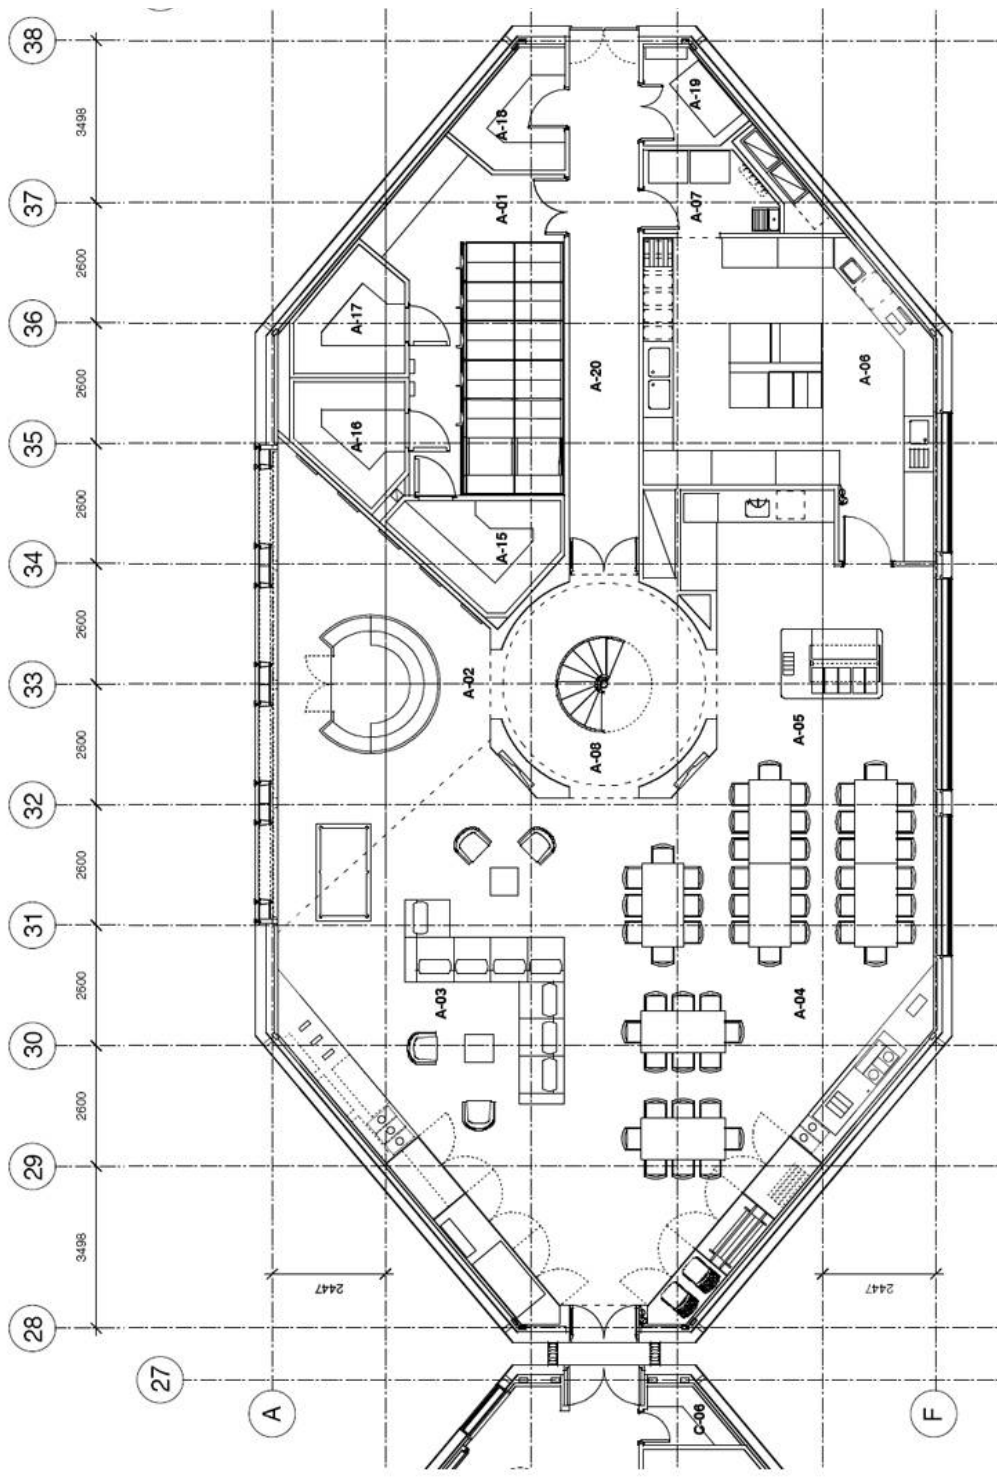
| GRUNDRISS, GESCHOSS 1, ZENTALES SOZIALMODUL, 388 m²
